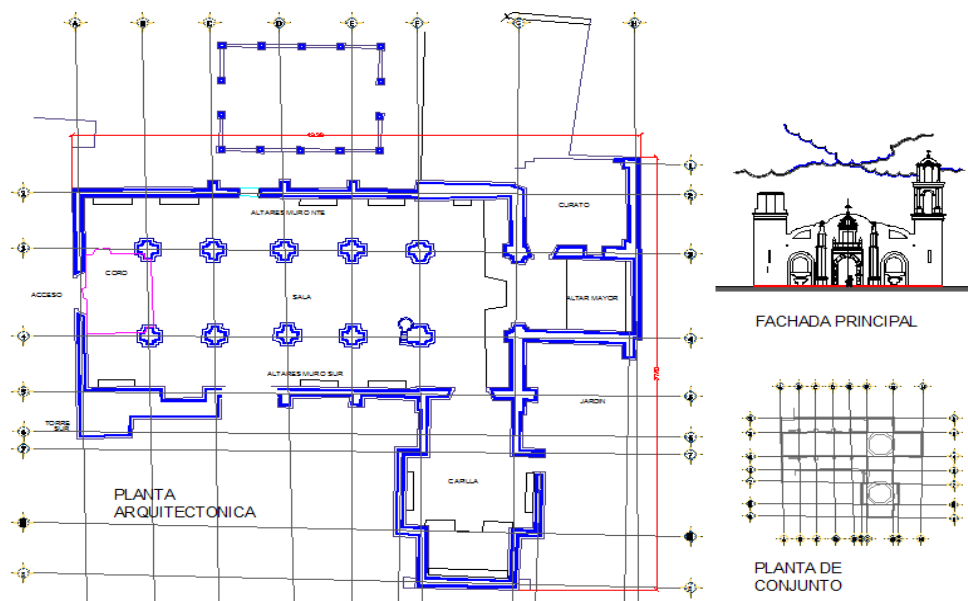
Planta Arquitectónica del Templo de Santa Anita; Fuente del Plano: Maestra María del Carmen Gonzales Cedeño.
